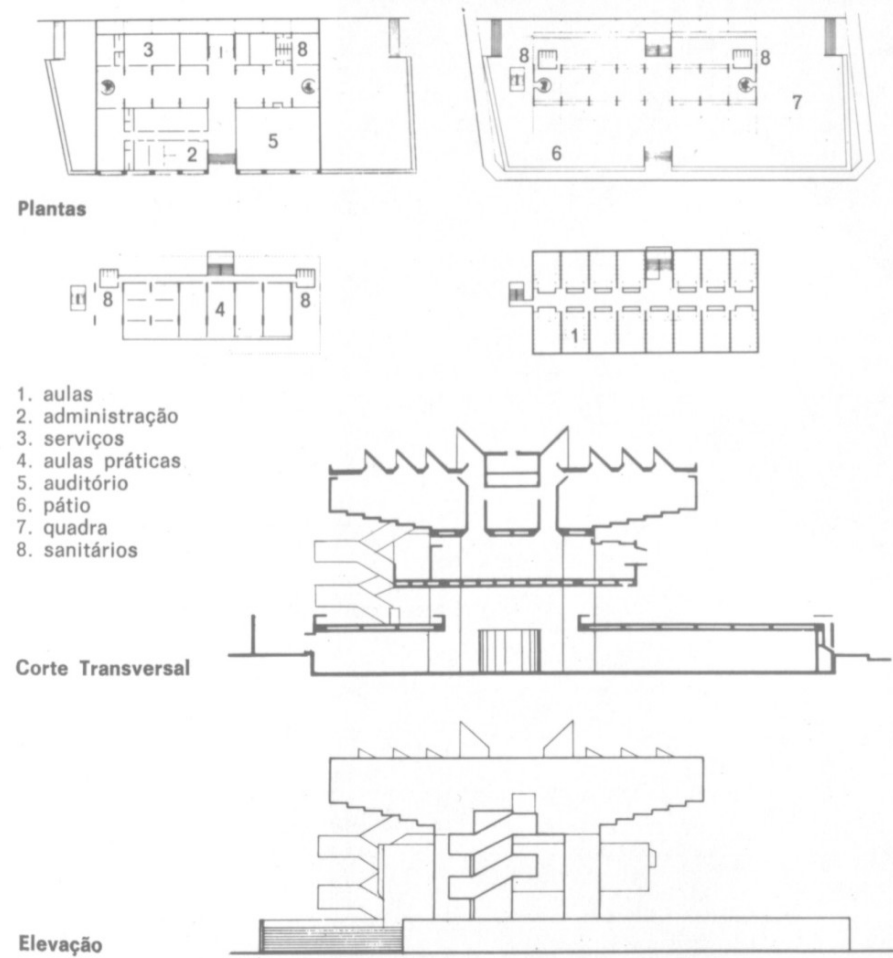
Plantas, cortes e elevações da Escola Acácio Sampaio. Fonte: Cadernos Brasileiros de Arquitetura, volume 4. Arquiteto Décio Tozzi, setembro de 1978, p. 21.
